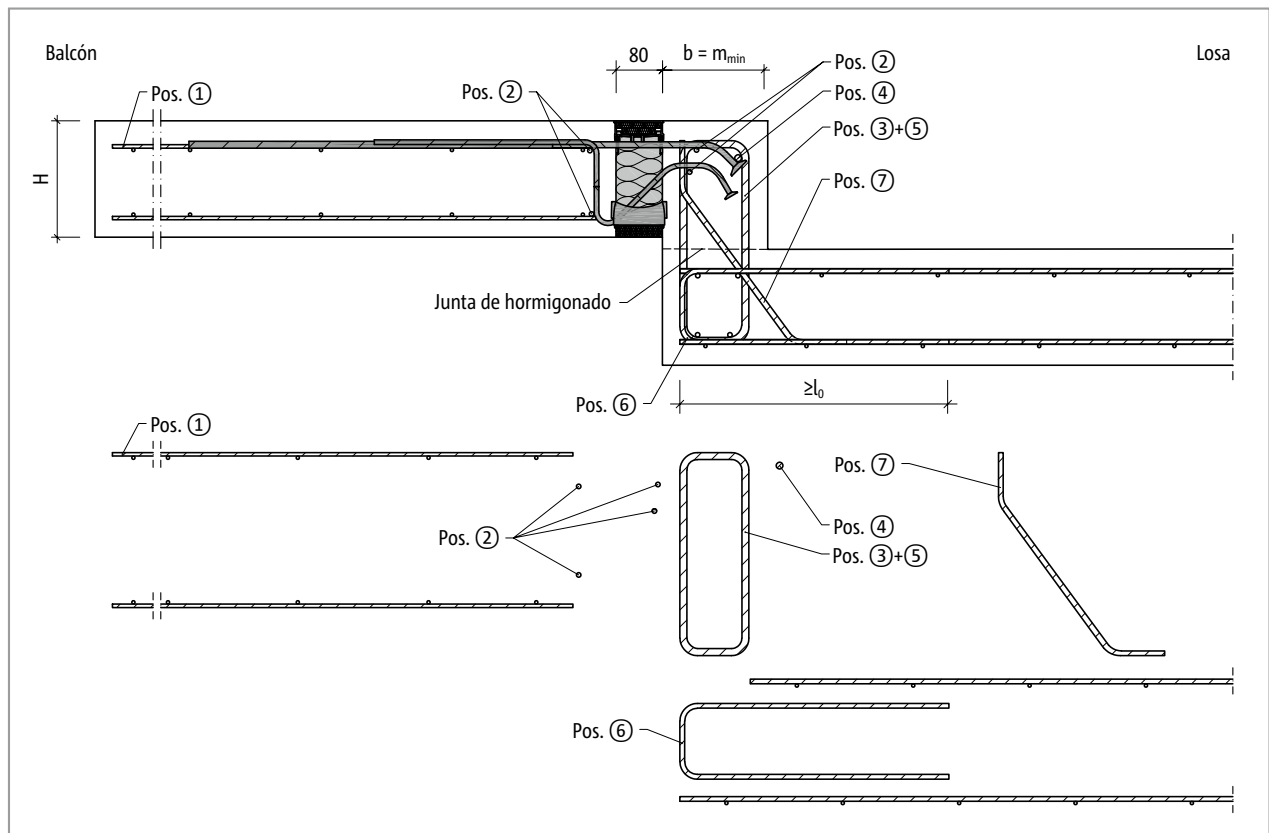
Schöck Isokorb® T tipo K-O: Armadura in situ para balcón con desplazamiento de altura hacia arriba con dimensión mínima del elemento constructivo ($m_{\text{exist}} = m_{\text{min}}$)
